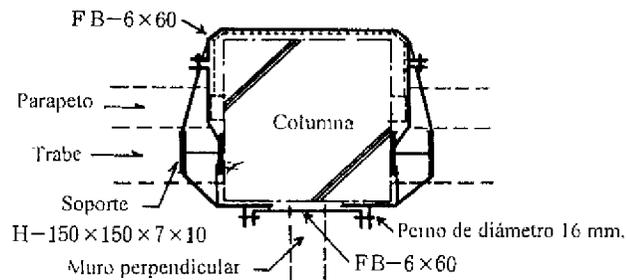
Detalle del refuerzo inmediato de emergencia con soporte de acero
